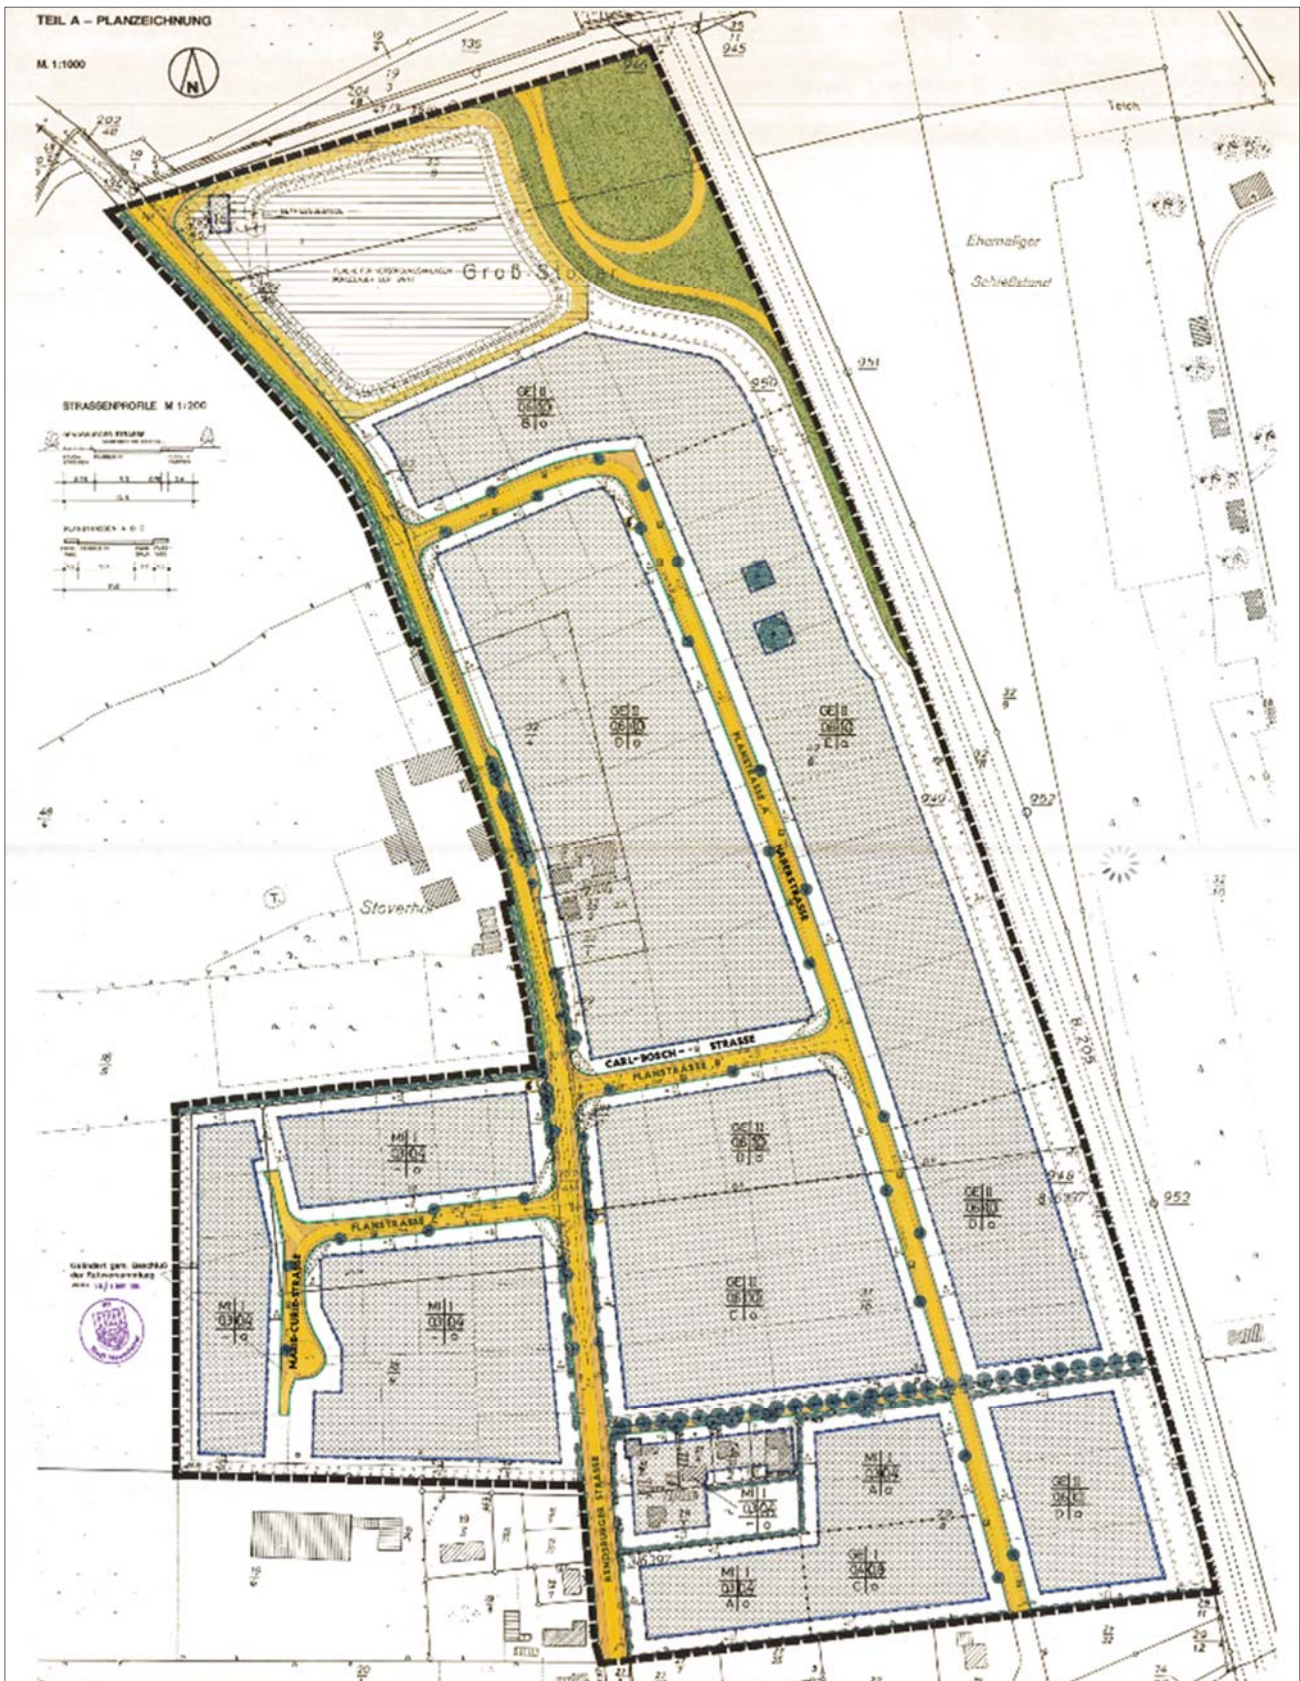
Auszug vom Bebauungsplan Nr. 67 (Ursprungsplan) „Gewerbegebiet Stover“
